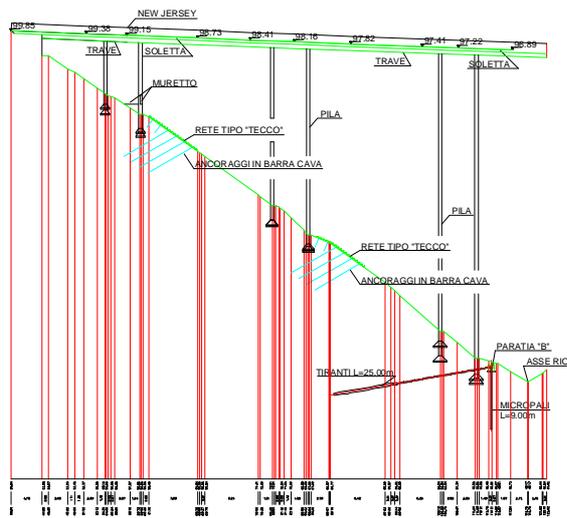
Sezione schematica degli interventi al Viadotto Teccio
